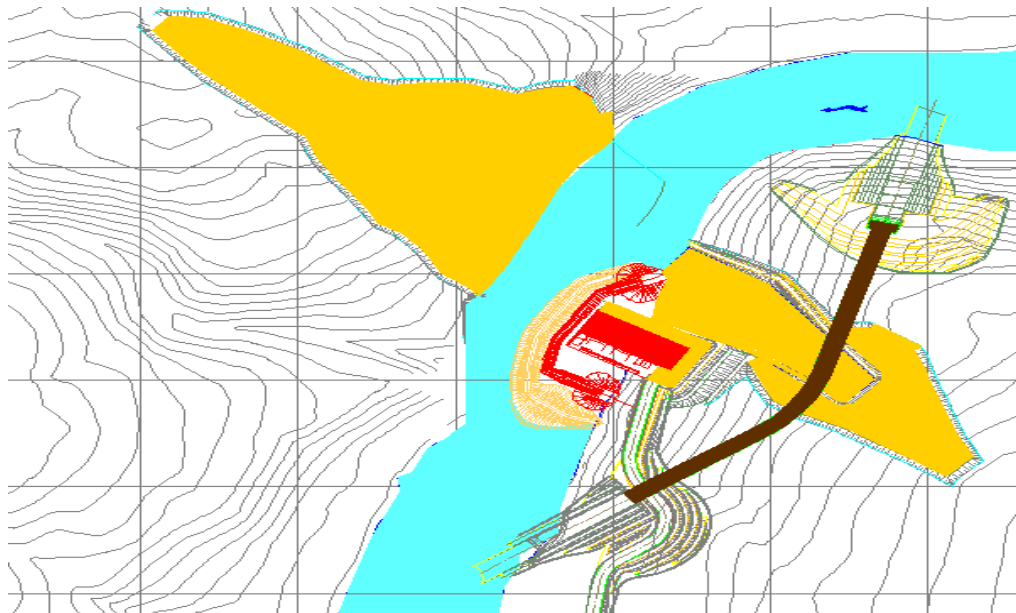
Etapa 2 - a) concretagem da estrutura de emboque do túnel de desvio e montagem das peças fixas; b) escavação da fundação da barragem de enrocamento na região da barragem de CCR; c) escavação do circuito de geração e fundações da casa de força; d) início da concretagem da casa de força; e) conclusão das escavações subterrâneas do túnel de desvio.
